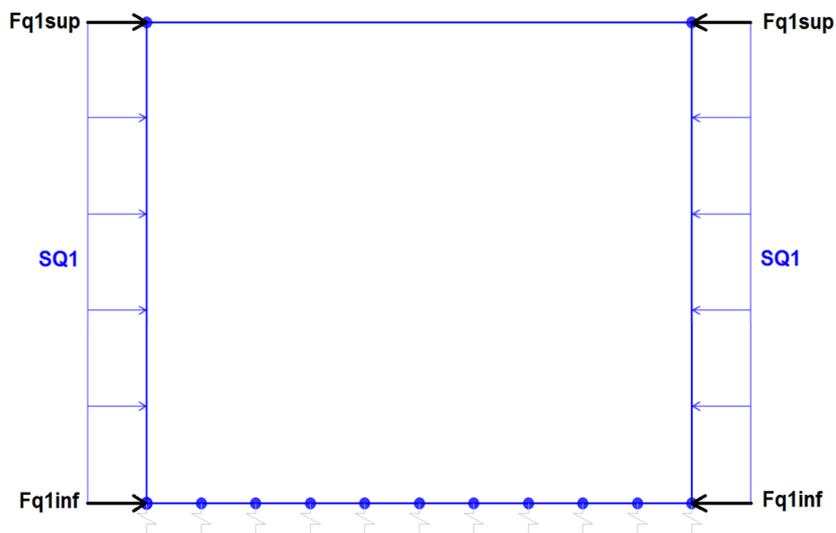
Condizione di carico SPACCSX e SPACCDX da SAP2000
